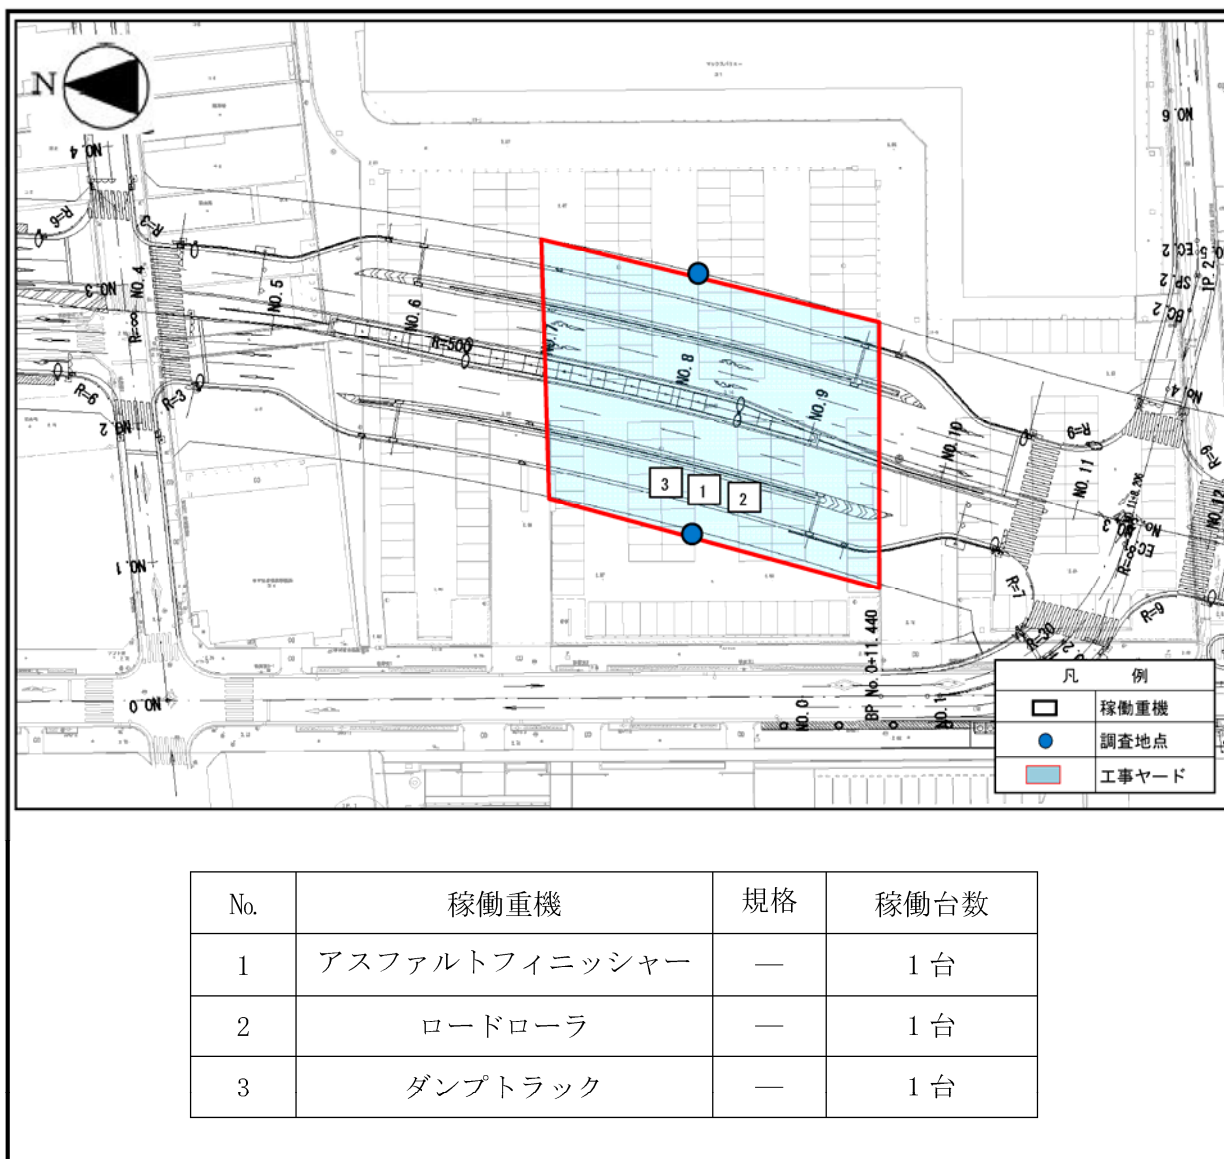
建設機械配置図（舗装工事(舗装工（アスファルト））：太閤地区平面部）
